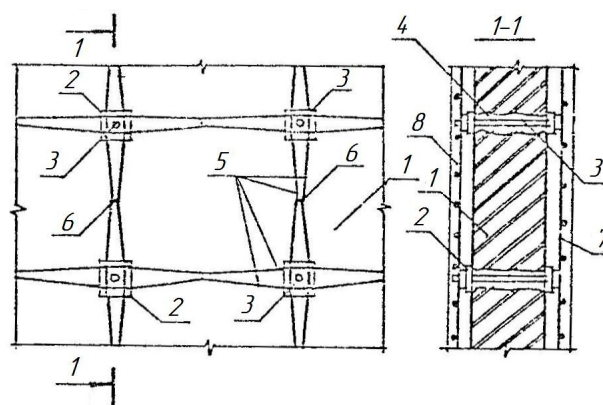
Улаштування арматурної попередньо напруженої обойми:
